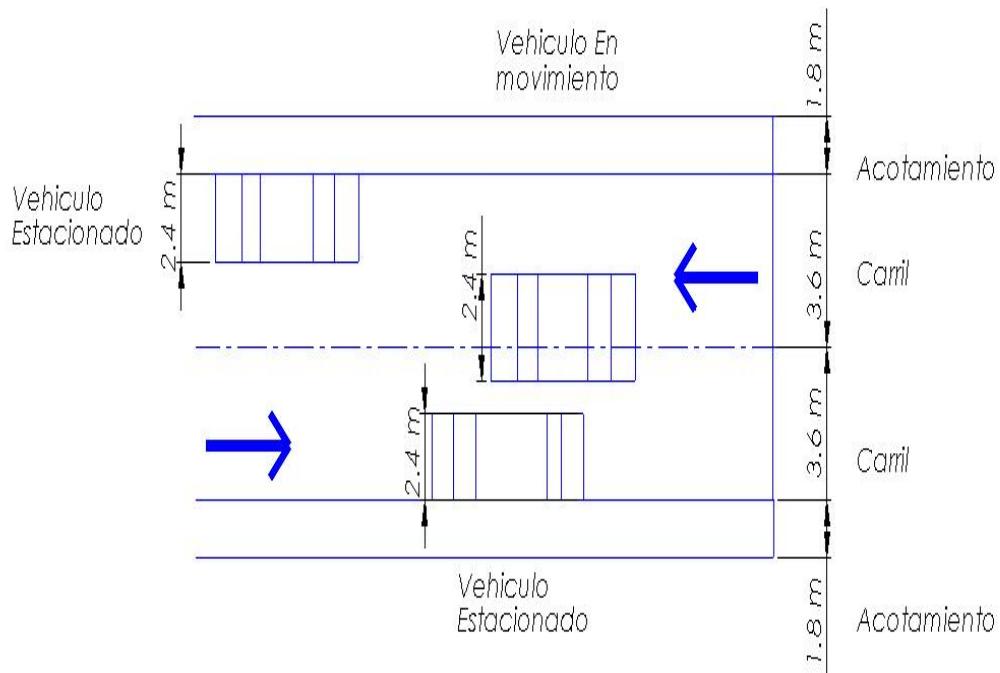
Sección vista de planta de las problemáticas de circulación, [6].
